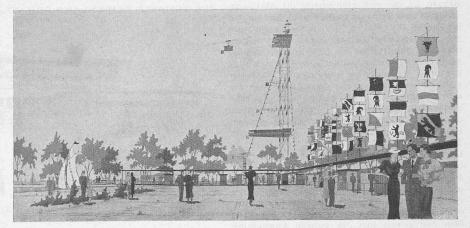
Linksufriger Haupteingang mit dem Turm der Zürichsee-Schwebebahn
